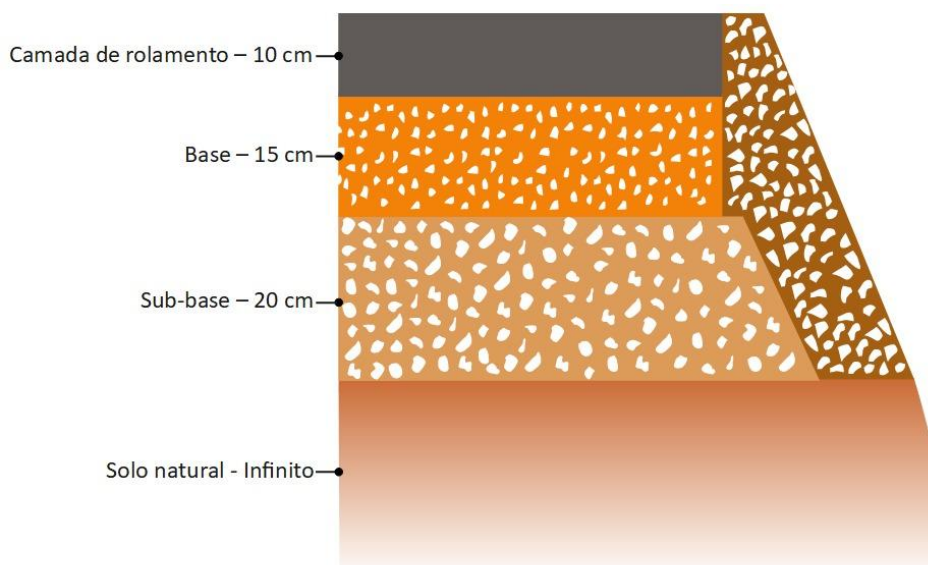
ECP com Pavimento de Concreto Asfáltico Espesso (PCAE) – pista dupla
